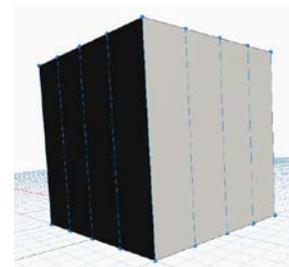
Sólido con vigas y columnas idealizadas obtenidas a partir del módulo de estructuración.
